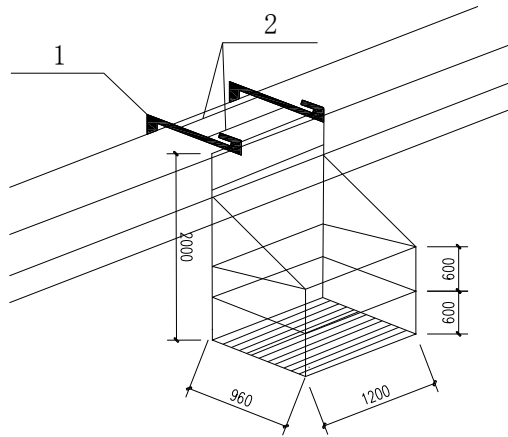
钢结构操作挂篮示意图（单位：mm）
